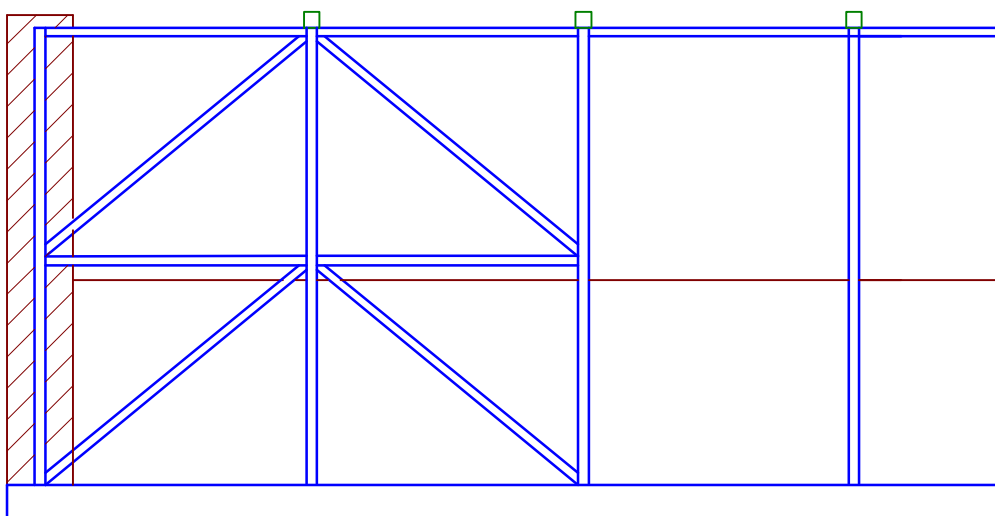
Esquema de la estructura metálica construida para soportar las vigas reticuladas y arriostrar el muro transversal.
